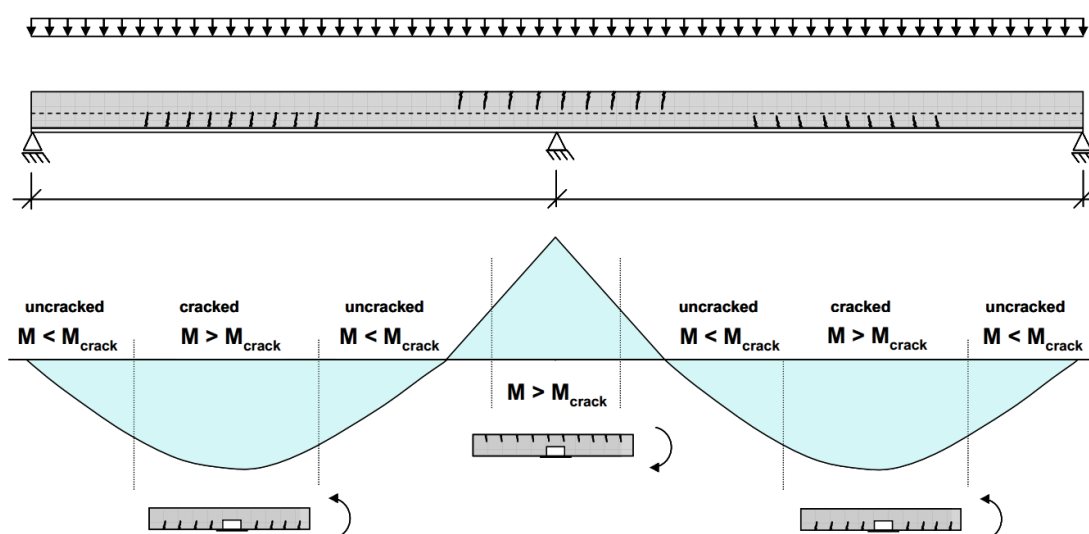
Efeito da fendilhação do betão em vigas mistas *slimfloor
